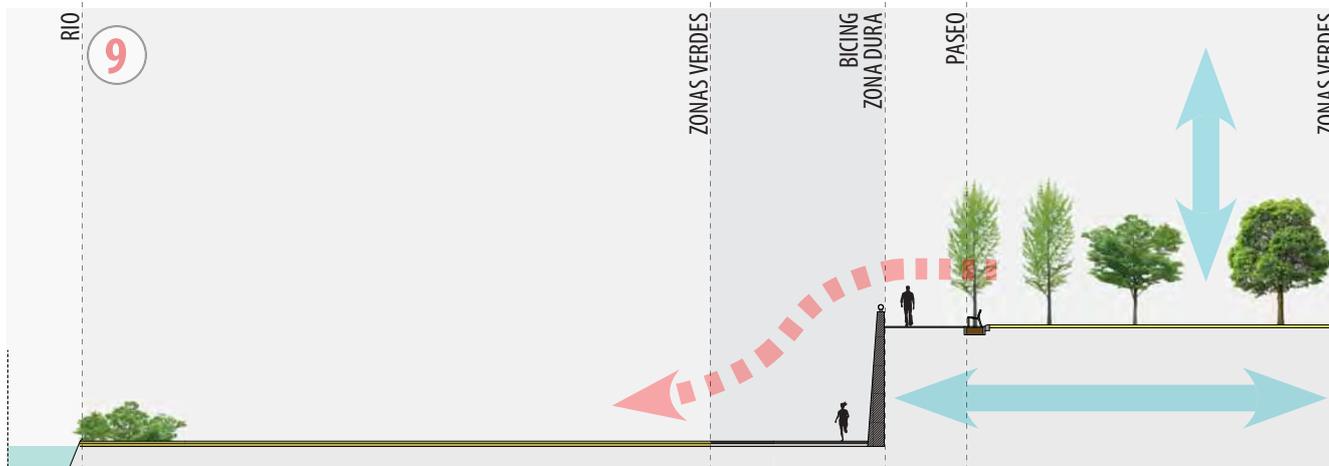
Sección tipo entre puente viejo de Santa Coloma-Acceso Can Zam Nord
